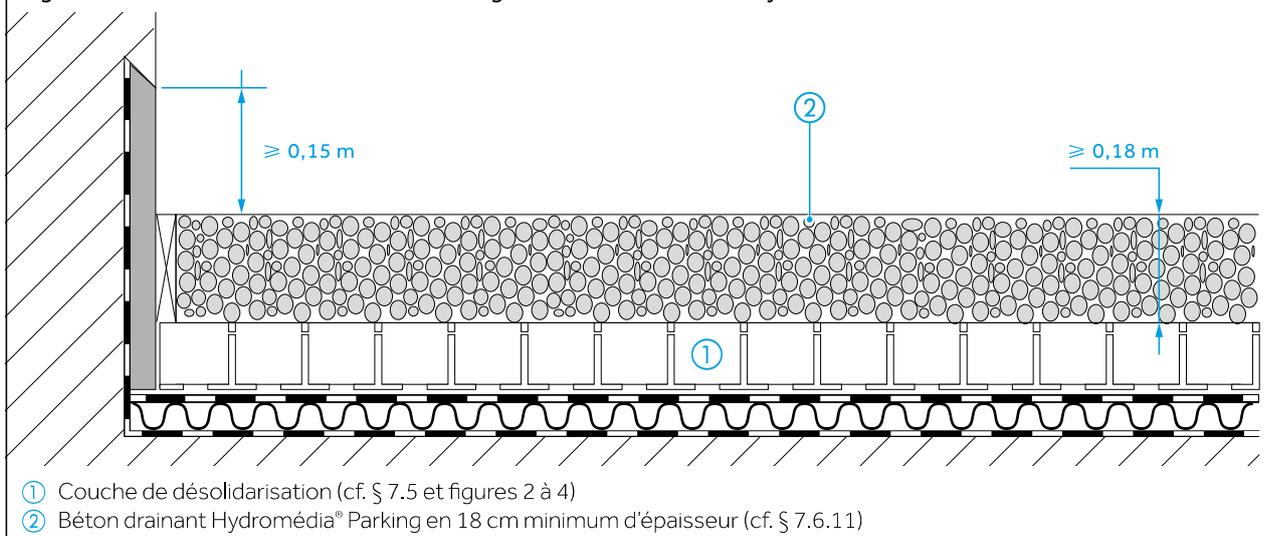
Toiture accessible aux véhicules légers avec dalles en béton drainantes
